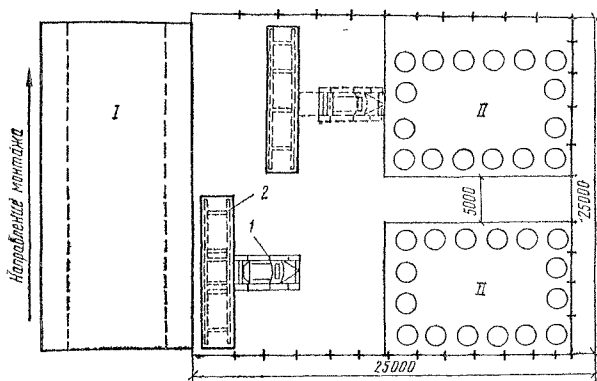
Схема организации работ при монтаже воздуховодов на конвейере автопогрузчиком
